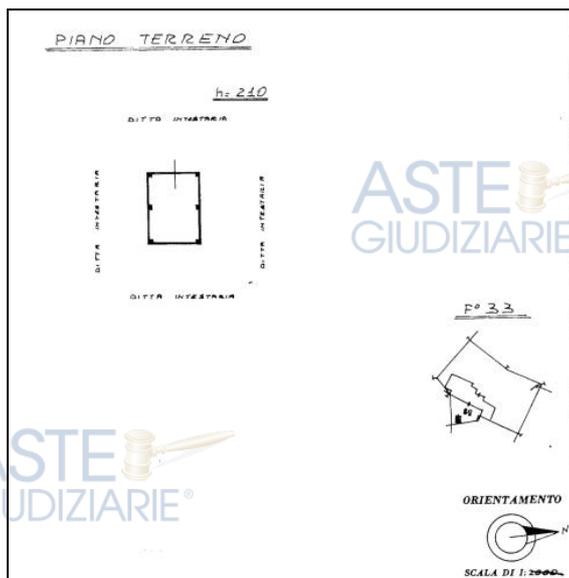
Estratto planimetria catastale (prot. n. T254869 del 05/12/1986)
